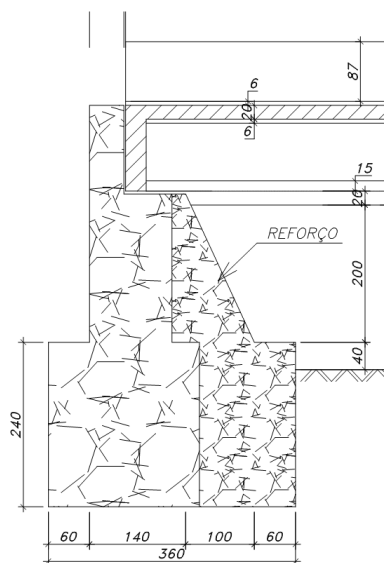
Seção transversal dos encontros após o reforço (Ponte sobre o rio Tamanduá - BR116/CE).
